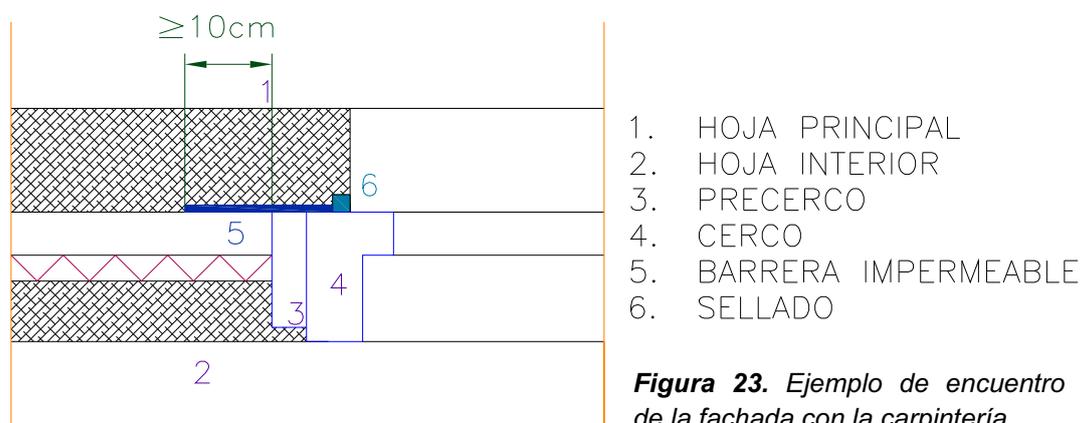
Ejemplo de encuentro de la fachada con la carpintería
